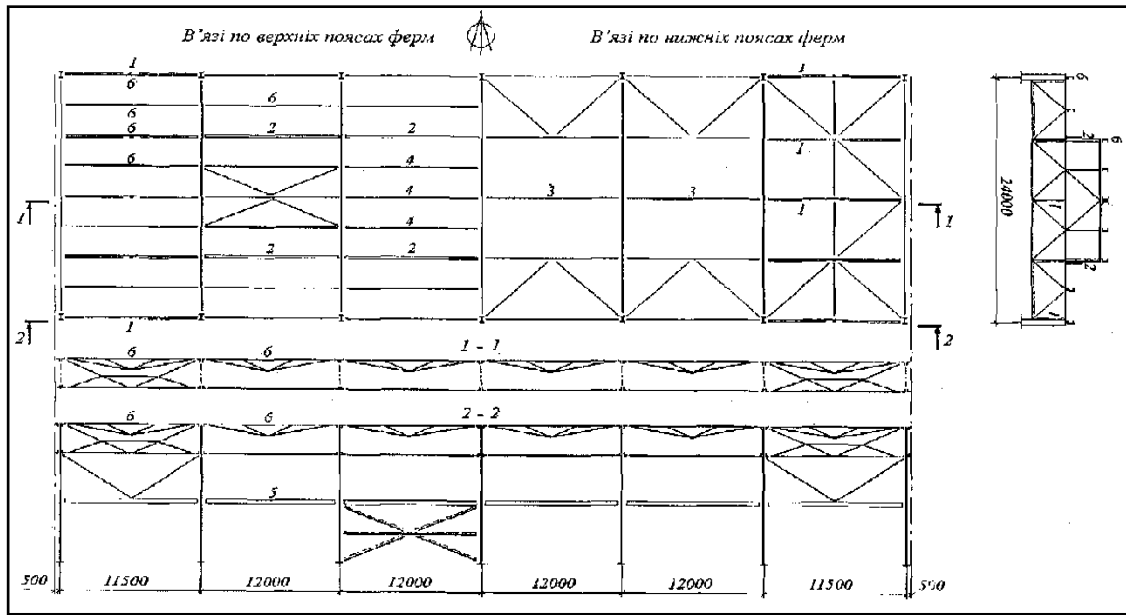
Схема в'язей каркаса при прогонному рішенні та кроці ферм і колон 12 м: 1 – вертикальні в'язі між фермами; 2 – ліхтарна панель; 3 – розтяжка; 4 – розпірка; 5 – підкранова балка; 6 – прогони
